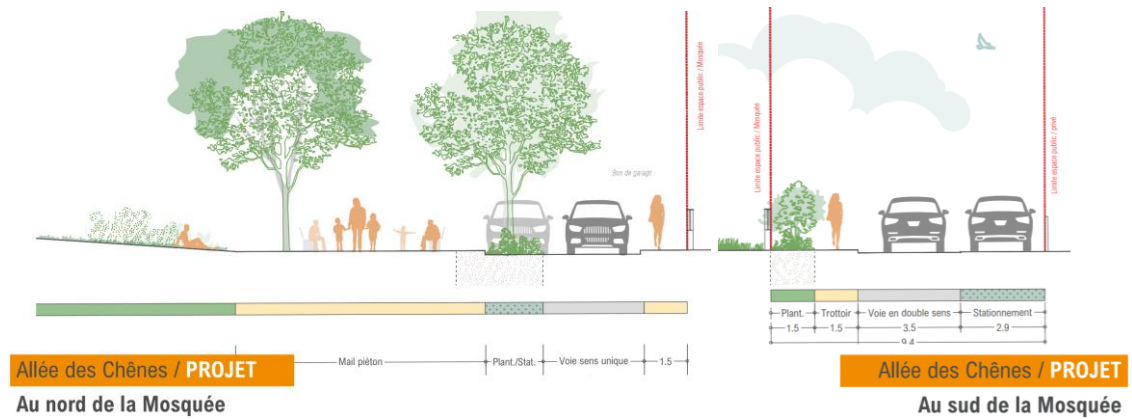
Plan de coupe de l'Allée des Chênes après projet (La Fabrique Urbaine, 06/2024)
